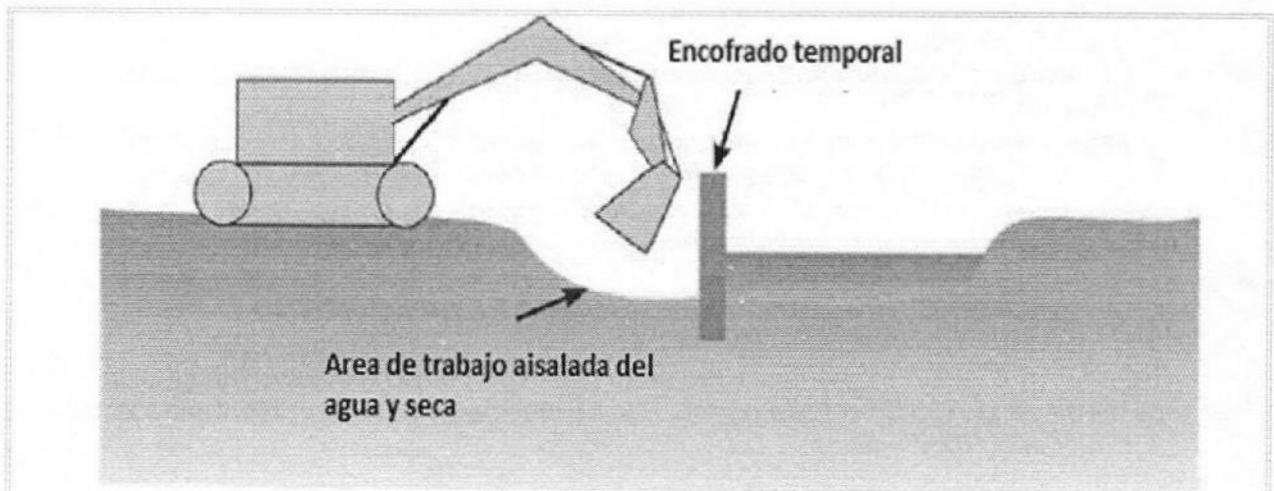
Aislamiento parcial con encofrado. Fuente: Adaptado de Engineering in the water environment. Good Practice SEPA 2009
